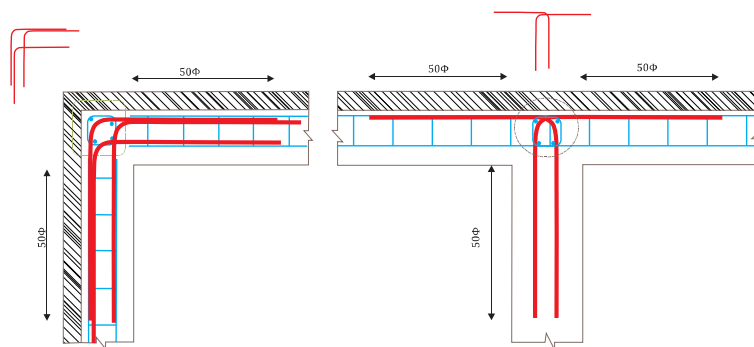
Exemple de liaisons entre chaînages horizontaux et chaînages verticaux
